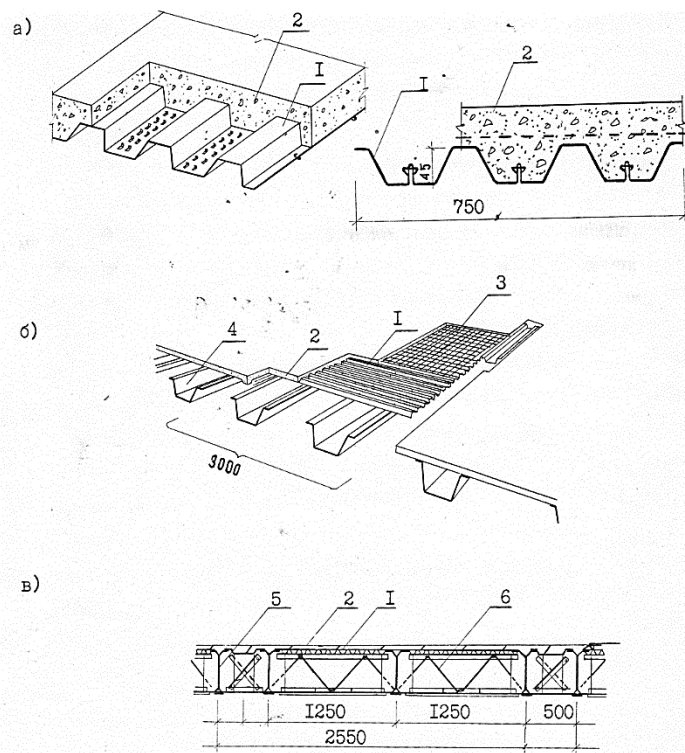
Конструкции перекрытий, возводимых в Финляндии (а) и Японии (б, в)
